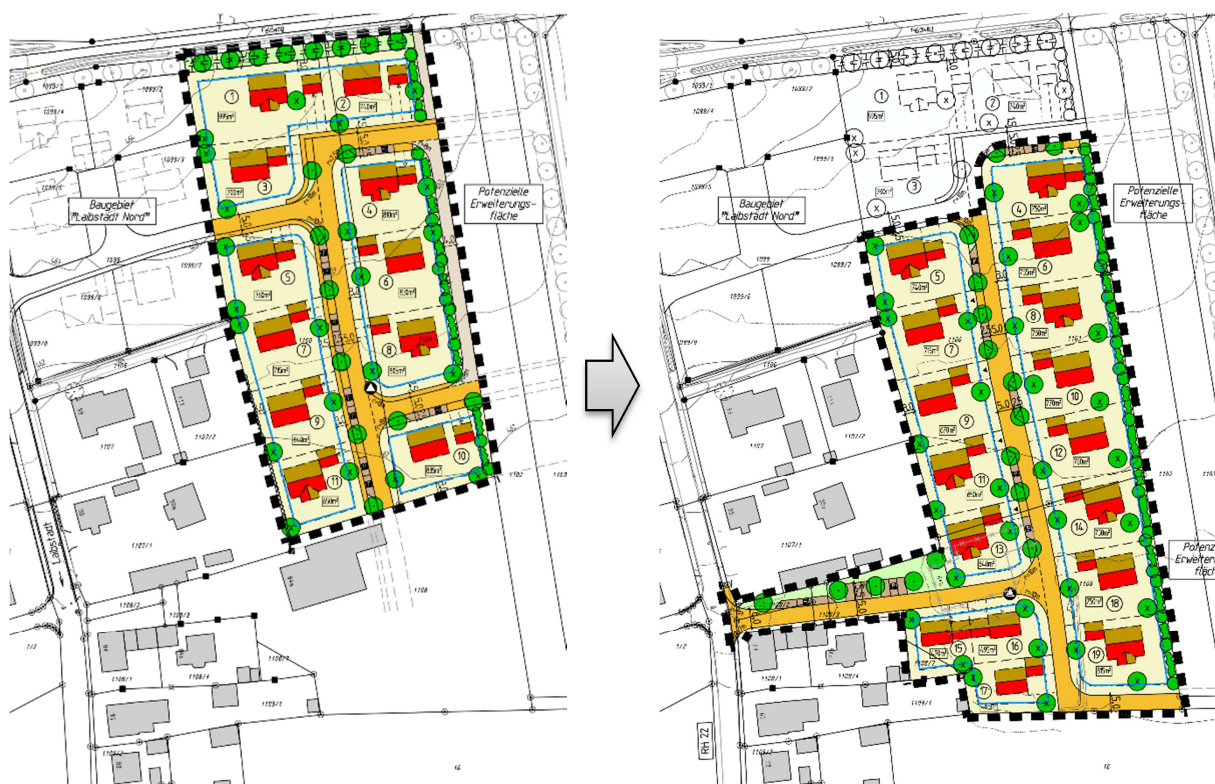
Baugelände „Laibstadt Nord II“, bisher rechtswirksamer Bebauungsplan (links) und 1. Änderung und Erweiterung (rechts) im Vergleich
